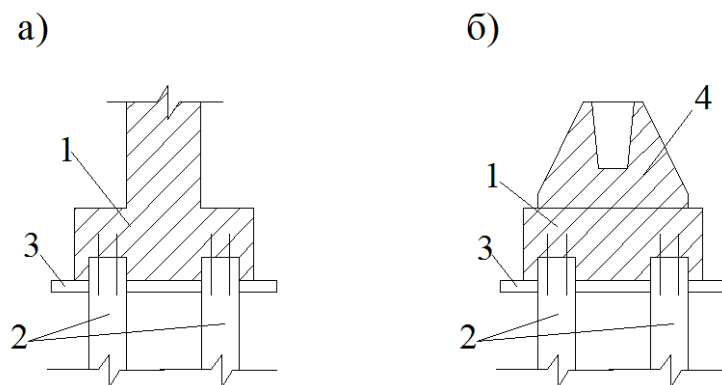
Конструктивная схема монолитного (а) и сборно-монолитного фундамента (б): 1- монолитный бетон с армированием; 2- НРСн; 3- бетонная подготовка; 4- сборный железобетонный элемент.
